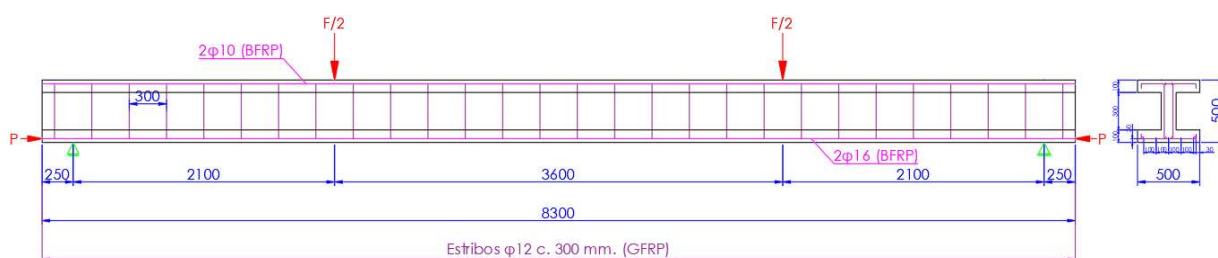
Esquema de configuración para viga H50CF (Dimensiones en milímetros)
